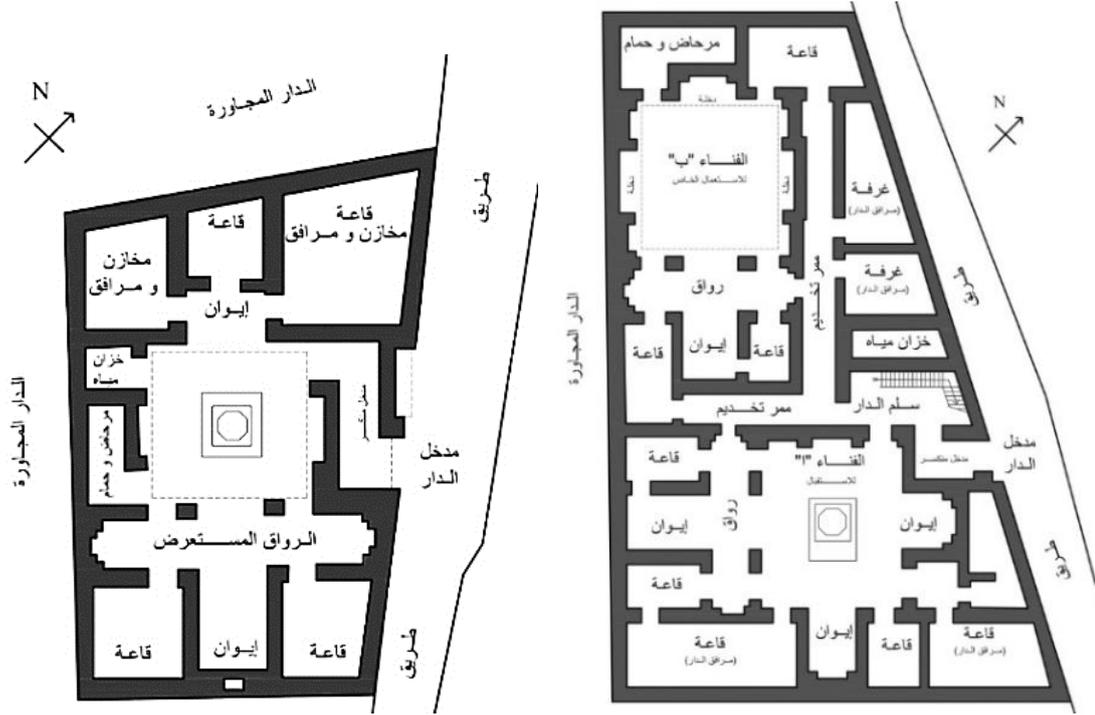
مسقط أفقي للنموذج الأول للدور الطولونية.
